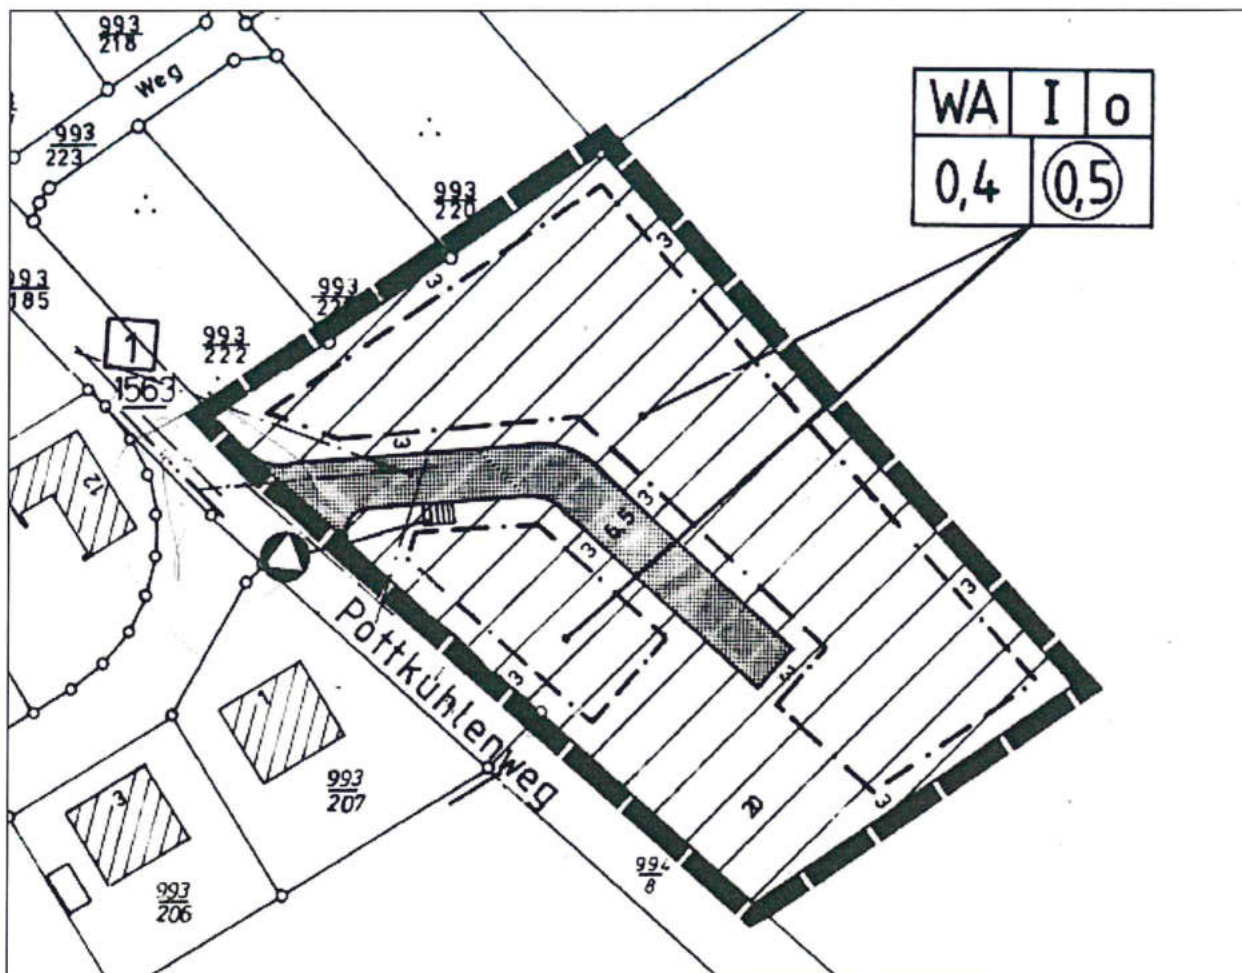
Bebauungsplan P 111 „Pottkuhlenweg I“ aus dem Jahr 1983
